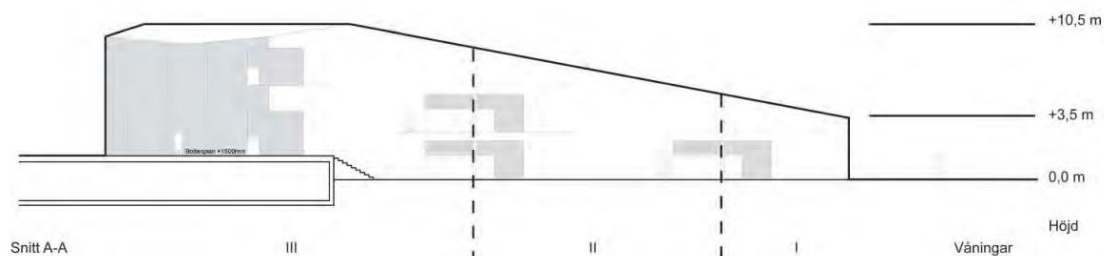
Detaljplan för kvarteret Ryktborsten.
